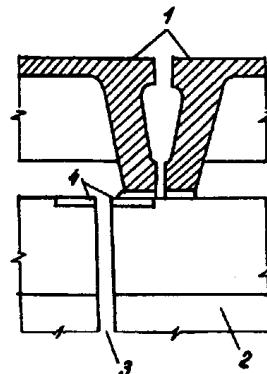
Схема опирания уширенных плит покрытия на стропильные конструкции у температурно-усадочного шва:
